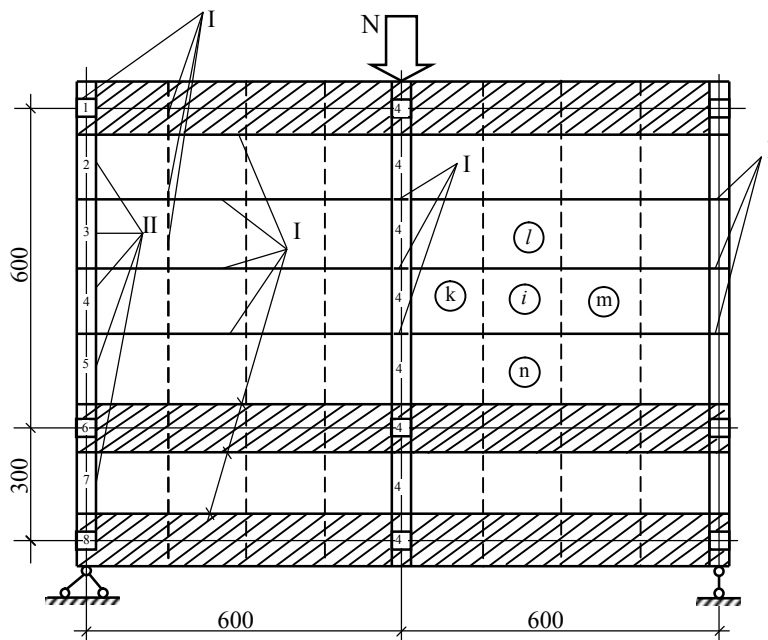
Фрагмент перекрытия собранного из типовых элементов многоэтажных каркасных зданий серии 1.020
